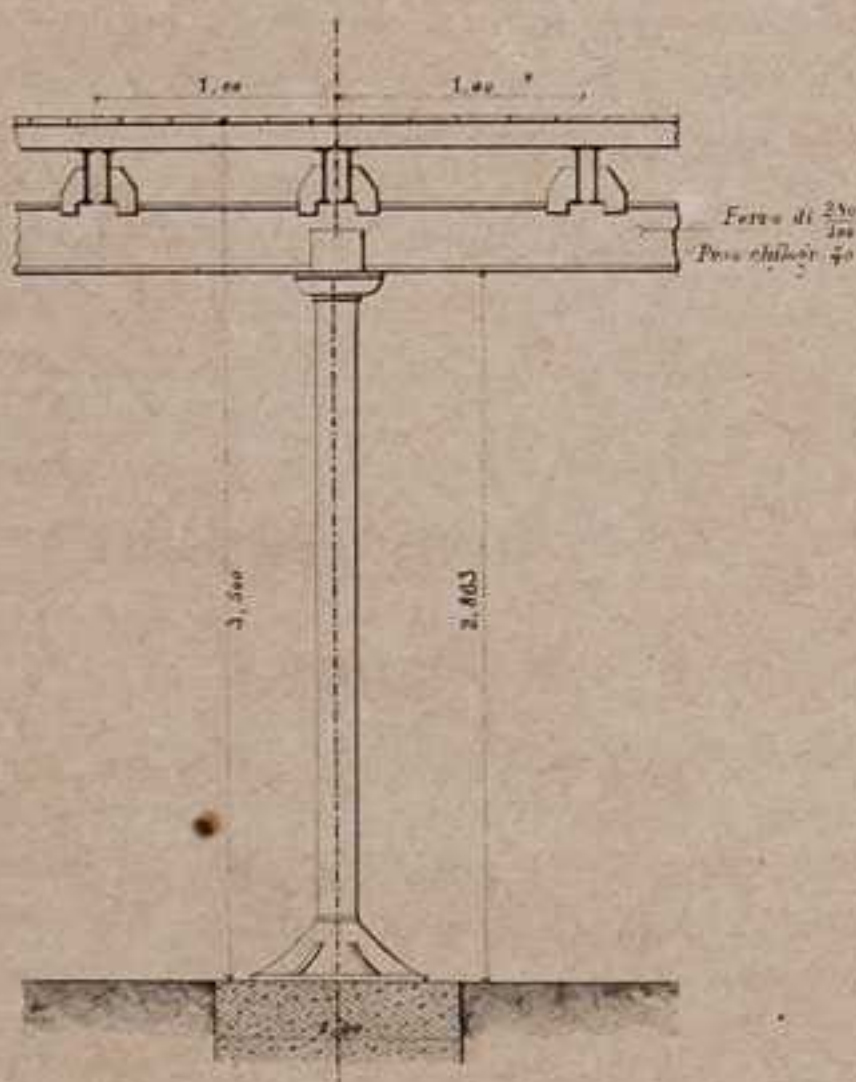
Sezione verticale normale all'asse delle gallerie superiori.
